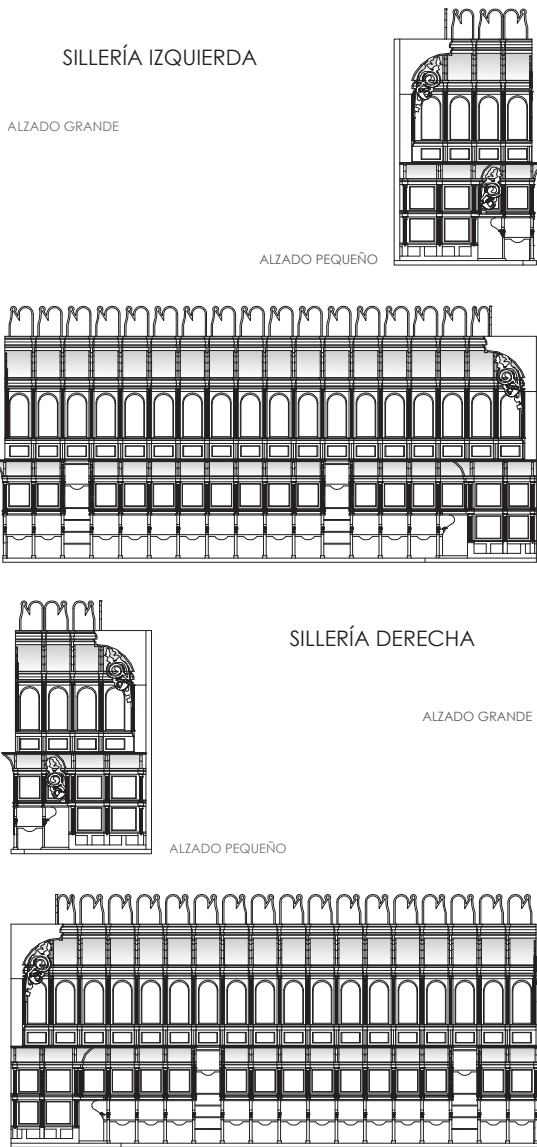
Alzados de la sillería del coro bajo. Elaborado por el autor.
